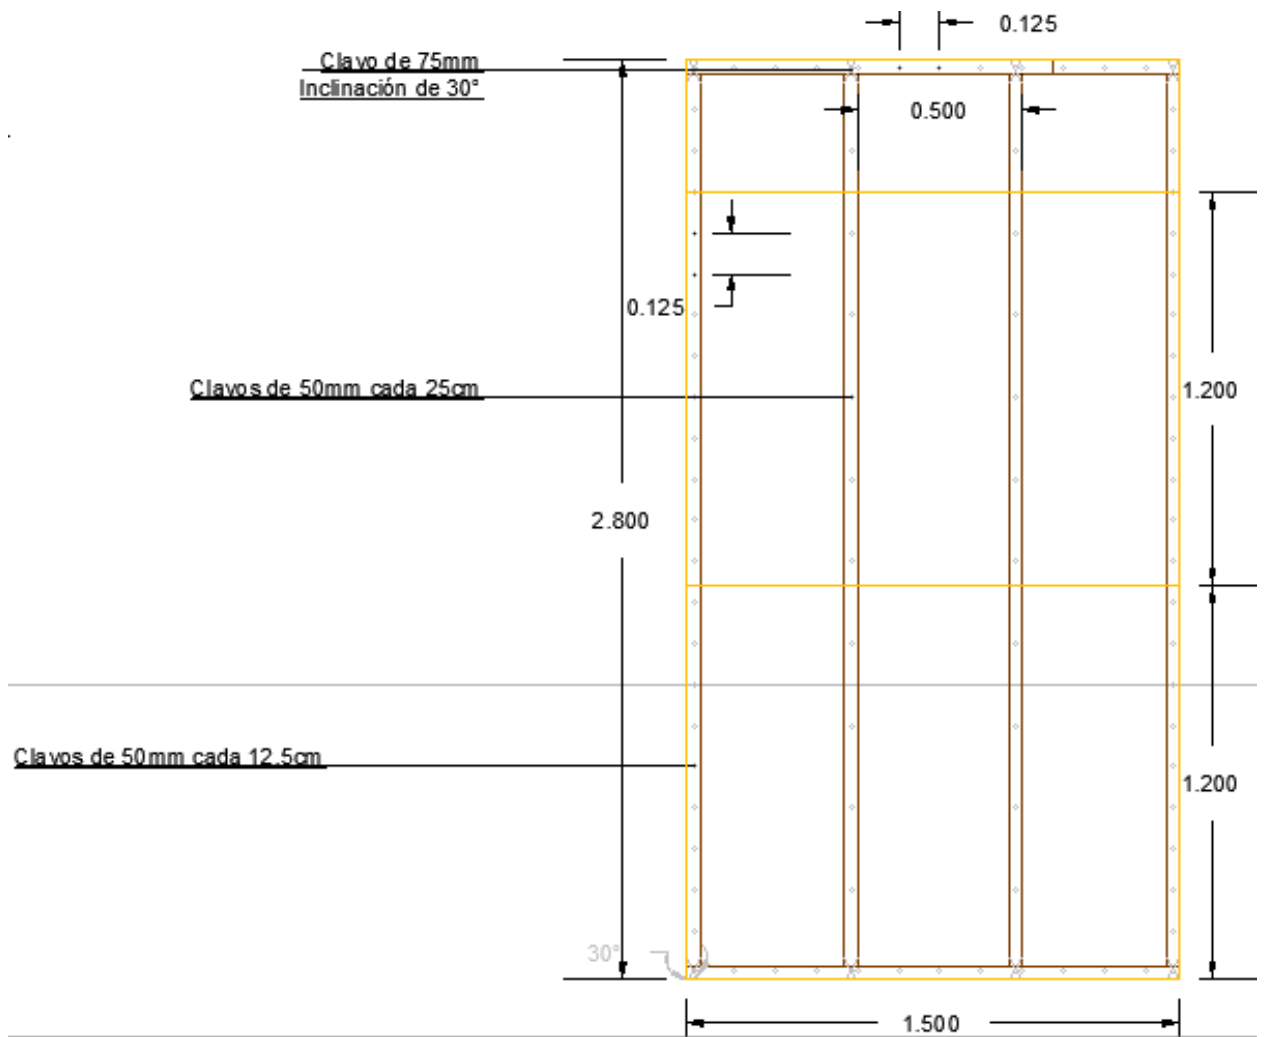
, Muro estructural M1 1.5 x 2.8 – vista frontal.
